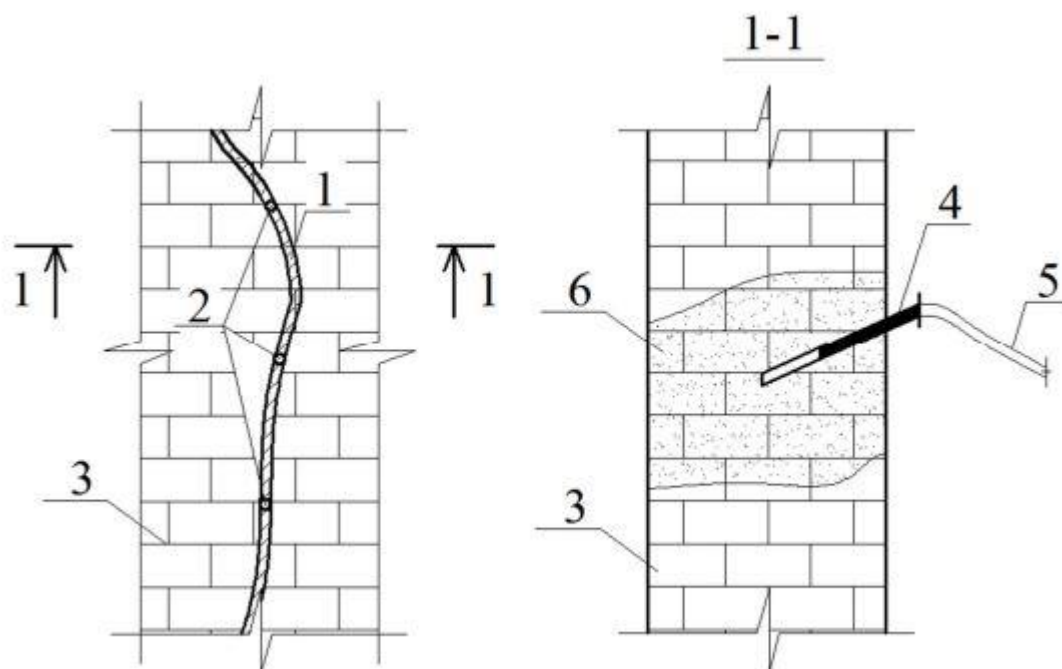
Технологическая схема восстановления каменной кладки 1 – трещина в стене; 2 – отверстия диаметром 20 мм; 3 – усиливаемая стена; 4 – инъекционные трубки; 5 – материальный шланг; 6 – зона поглощения укрепляющего раствора
